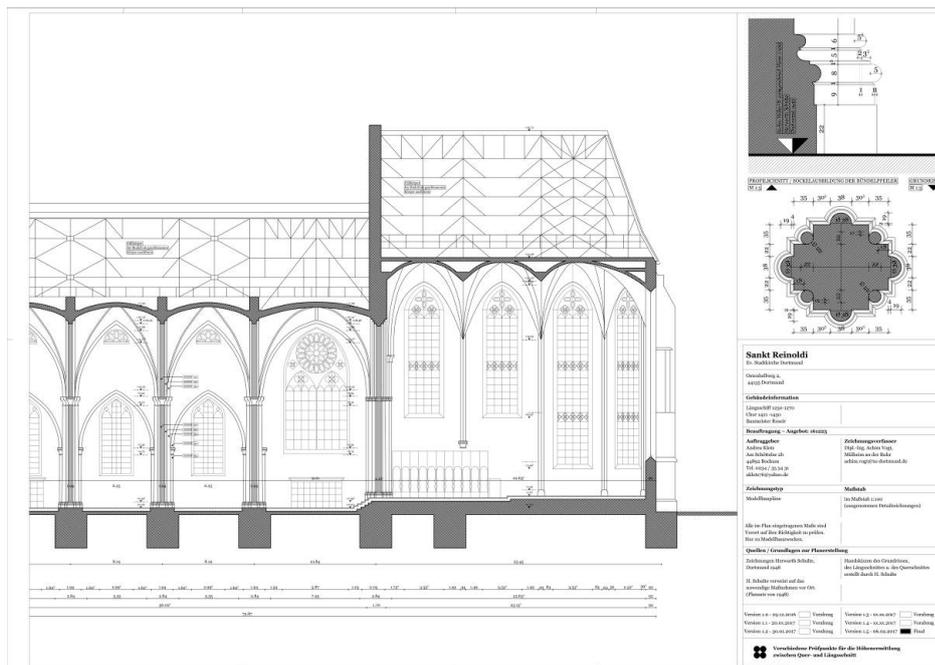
Digitaler Plan für nicht realisiertes Chormodell, Längsschnitt durch Chor, Maßstab 1:100 (ausgenommen Detailzeichnungen), erstellt durch Achim Vogt, PDF-Datei (84,1 x 59,4 cm). (© ak)
